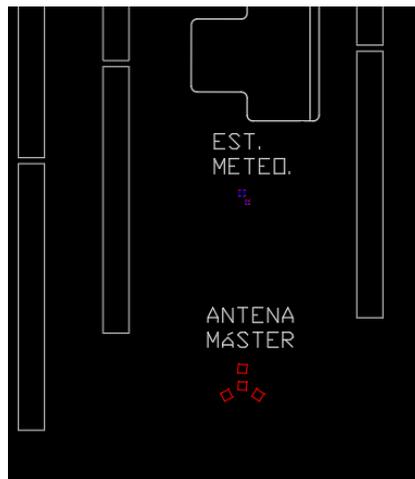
Levantamiento para as-built de antena máster y estaciones meteo
